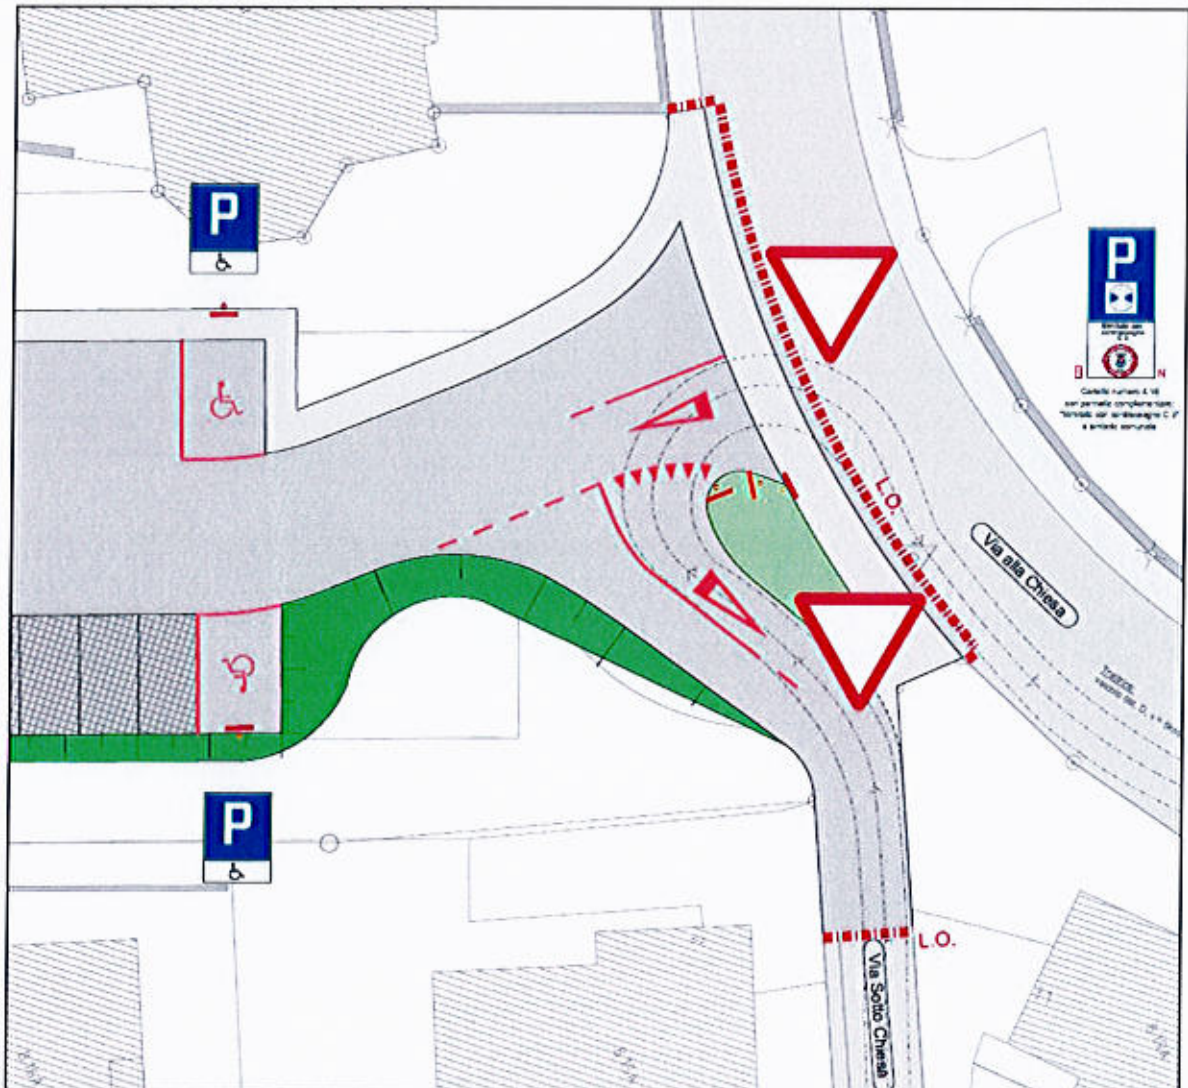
Estratto 19.38I-206 Planimetria segnaletica
